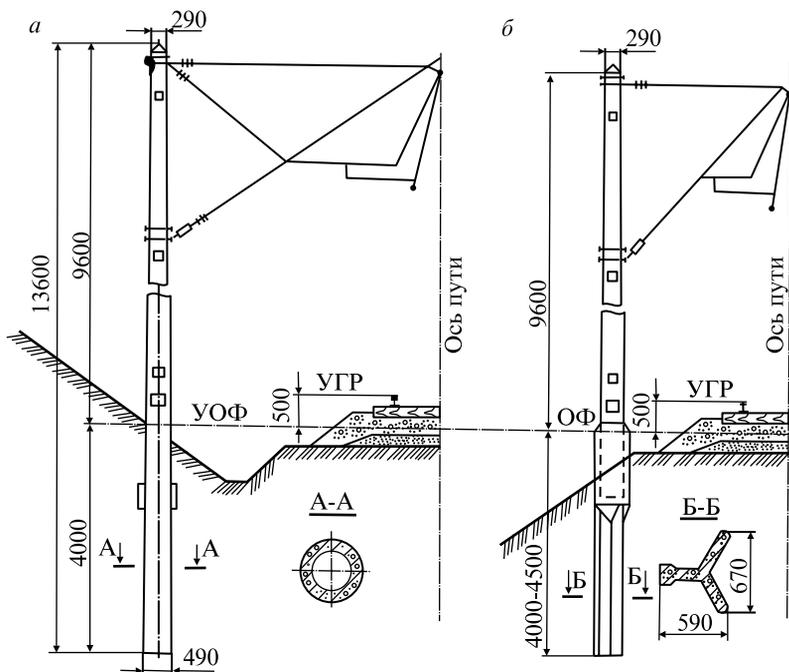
Унифицированные железобетонные консольные опоры контактной сети: *а* — нераздельная длиной 13,6 м с фундаментной частью; *б* — раздельная длиной 10,8 м на трехлучевом стаканном фундаменте; ОФ — обрез фундамента; УОФ — условный обрез фундамента; УГР — уровень головки рельса
